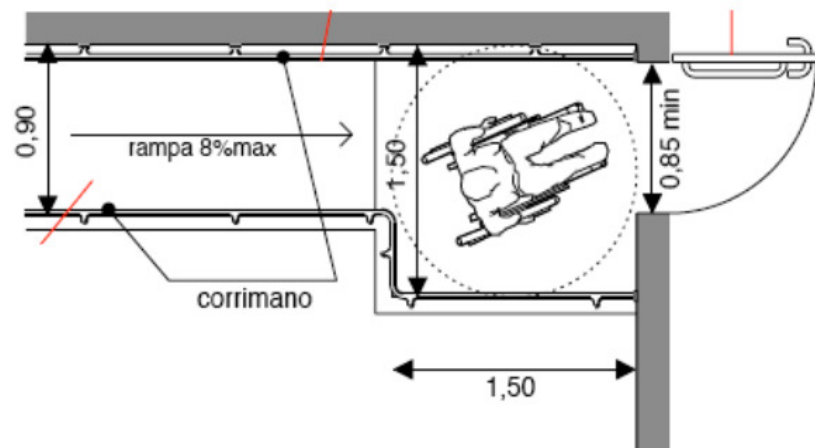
Schema planimetrico tipo con indicazioni dimensionali minime per accessi su rampa
